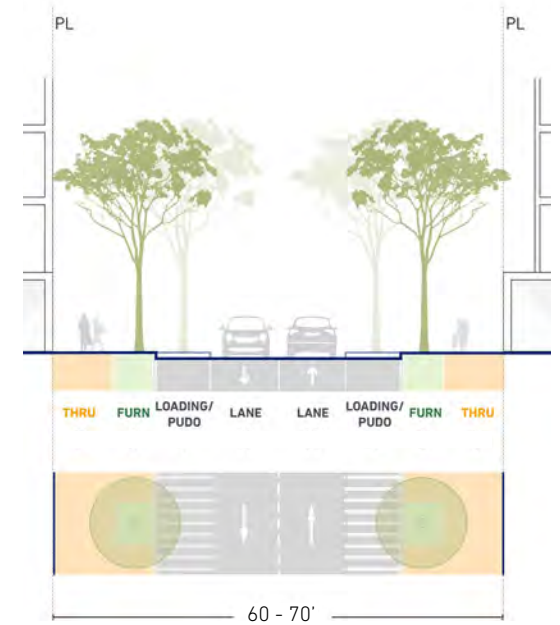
Sección de calle típica conceptual para las calles propuestas dentro de Station Block
